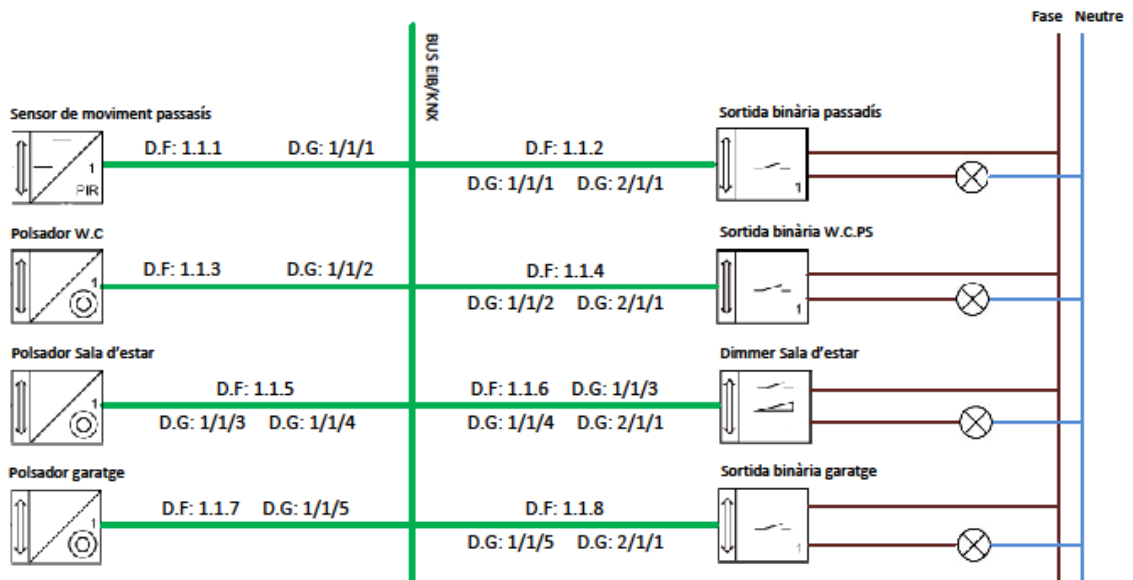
Esquema domòtic d' il·luminació planta subterrània
